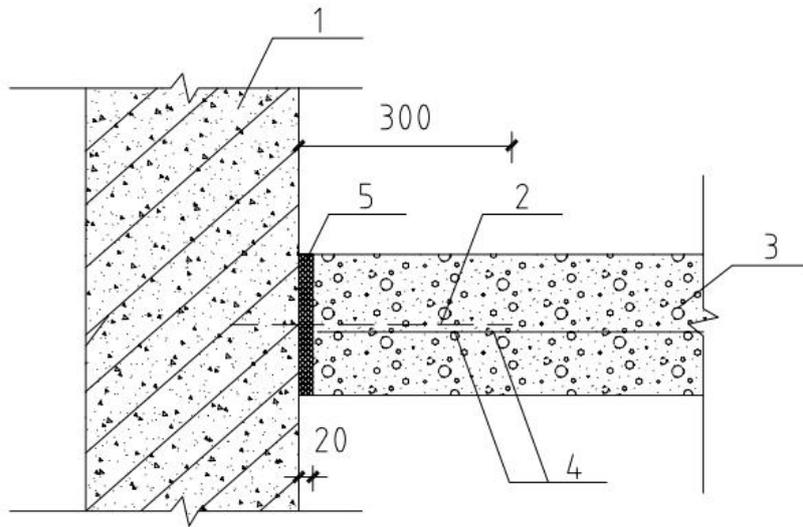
配单层钢丝焊接网的泡沫混凝土墙体与柱、墙连接示意
